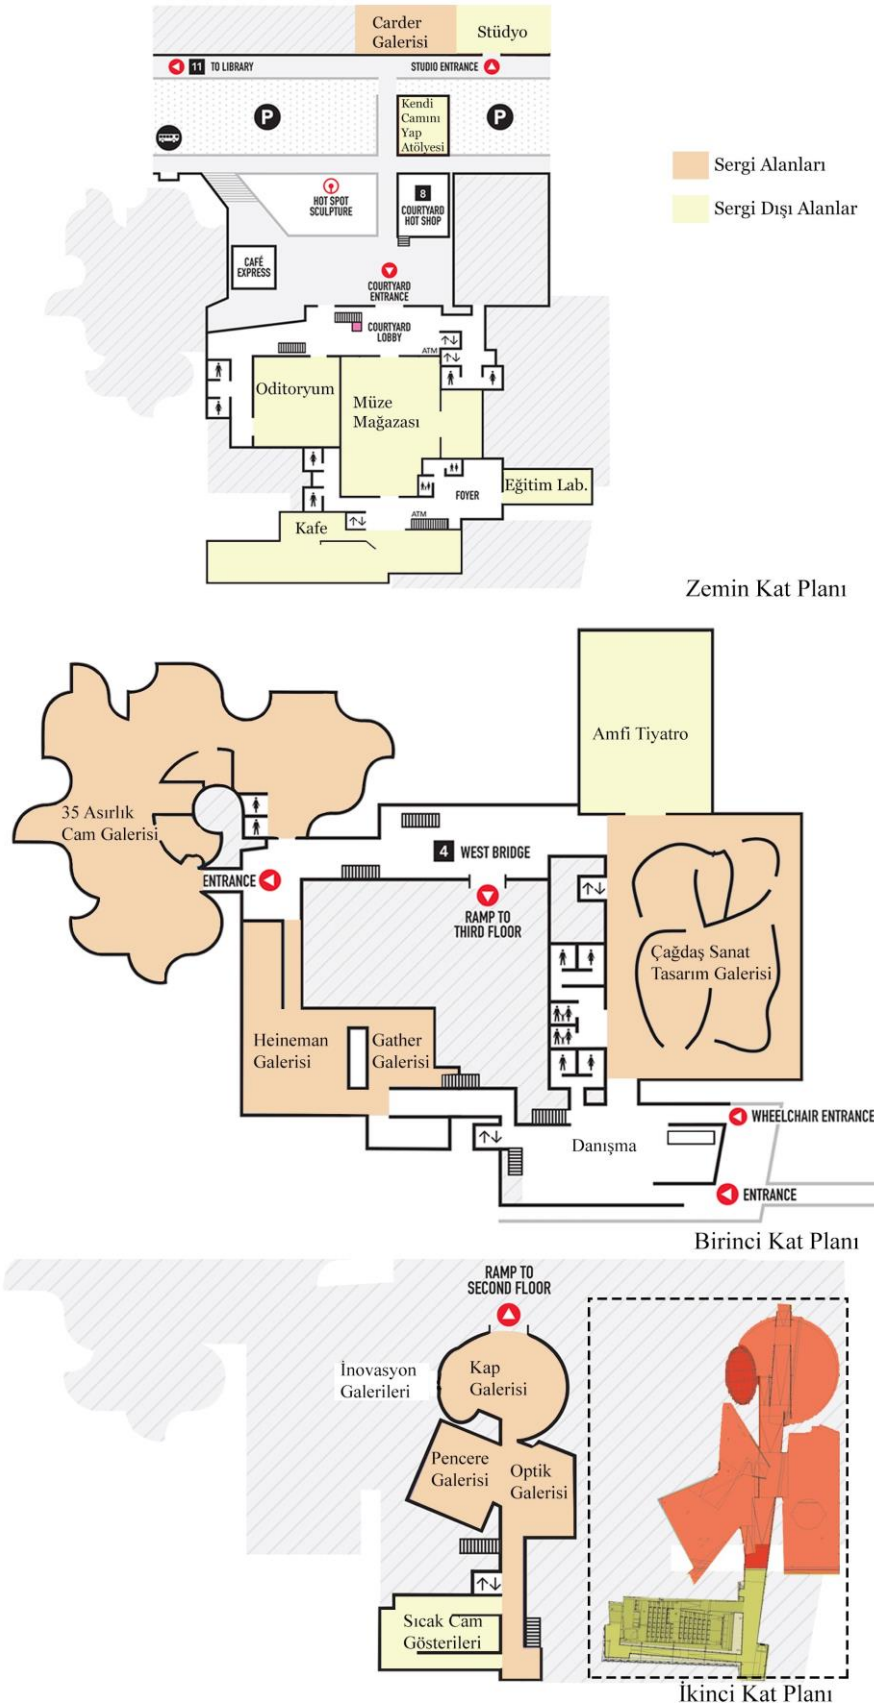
Corning Cam Müzesi kampüs vaziyet planı (URL-53) (Vaziyet planı yazar tarafından düzenlenmiştir.)
